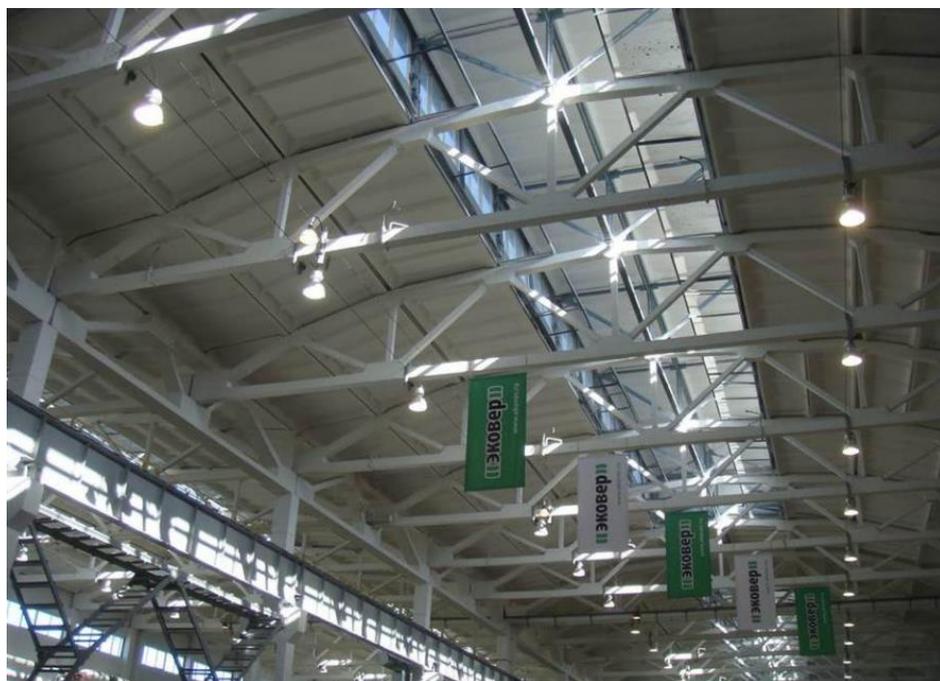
Ферми покриття попередньо напружені залізобетонні
